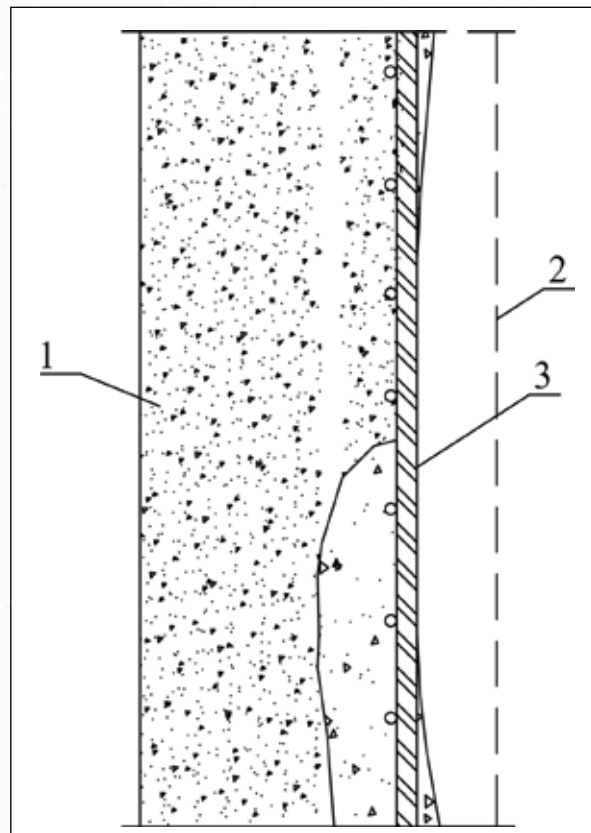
Состояние бетона до восстановления защитного слоя арматуры: 1 – железобетонная конструкция; 2 – грань конструкции до разрушения; 3 – арматура
